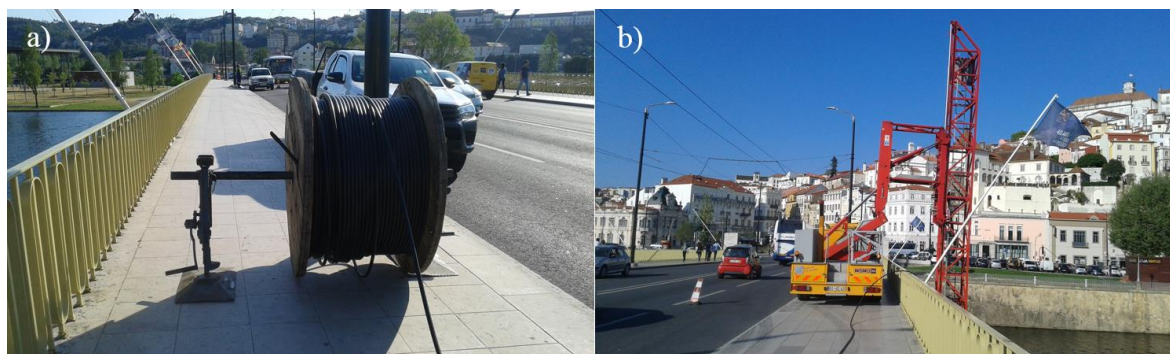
a) Bobina com cabo tripolar de BT da rede de IP instalado, b) grua *under bridge* em execução de trabalho.
